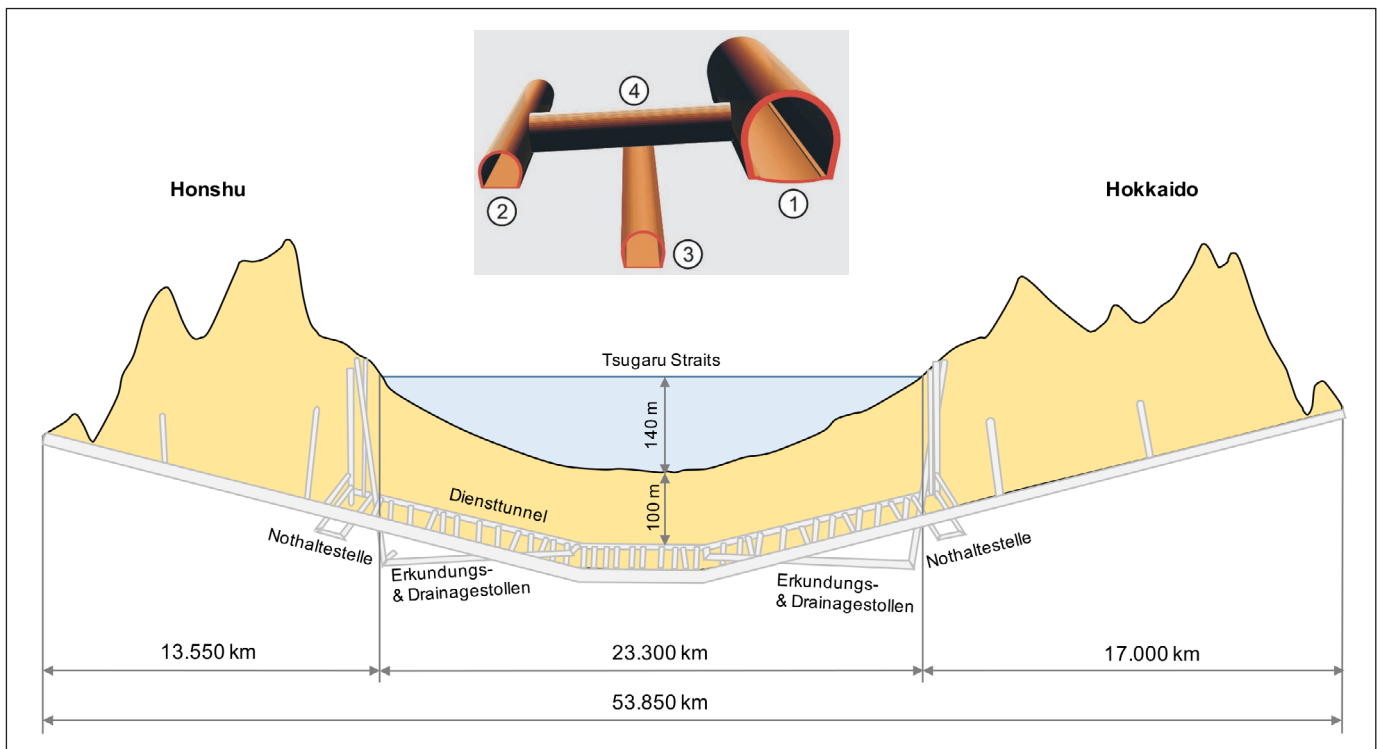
Tunnelsystem Seikan Tunnel (Japan), ① – Fahrrohre, ② – Diensttunnel, ③ – Erkundungsstollen, ④ – Verbindungsstollen (alle 600 m)
